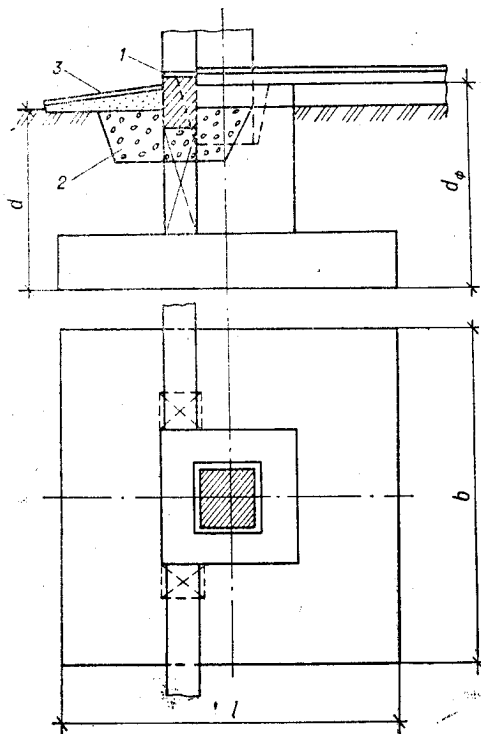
Монолітний залізобетонний фундамент під збірну залізобетонну колону:
